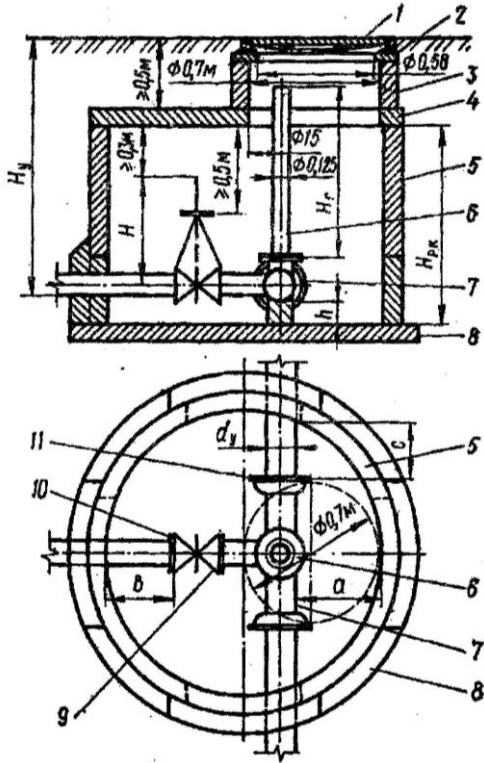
Схема водопровідного колодезя із круглих залізобетонних елементів
